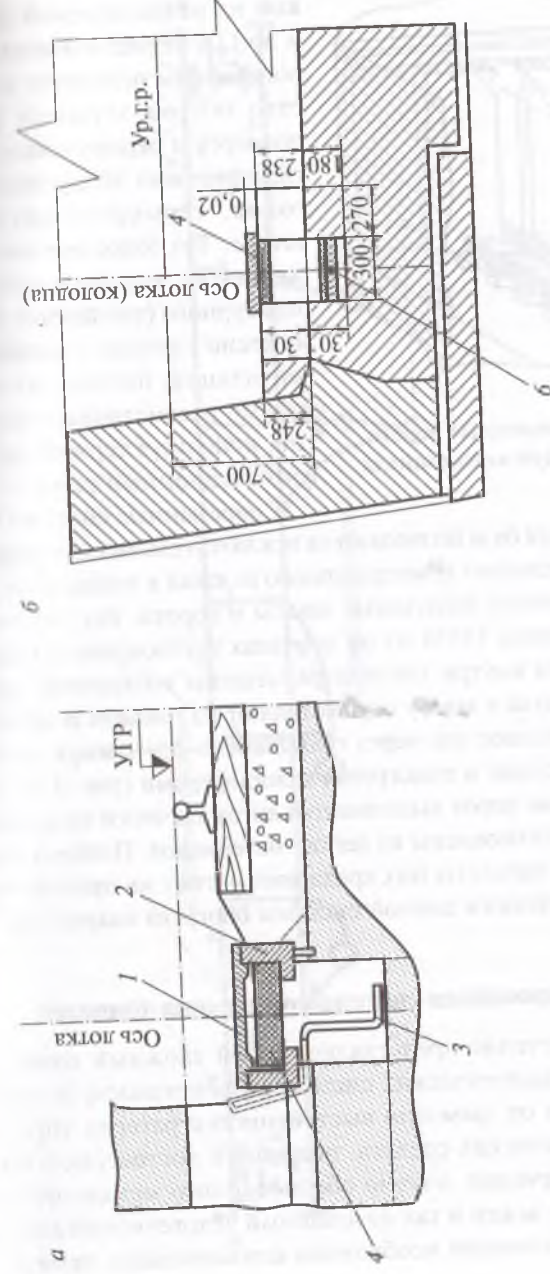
Электрообогрев водоотводного лотка ТЭНами (а) и греющим кабелем (б): 1 — железобетонная крышка; 2 — железобетонный блок; 3 — ТЭН; 4 — пенопласт; 5 — защитный слой из армированной цементной стяжки; 6 — греющий кабель
